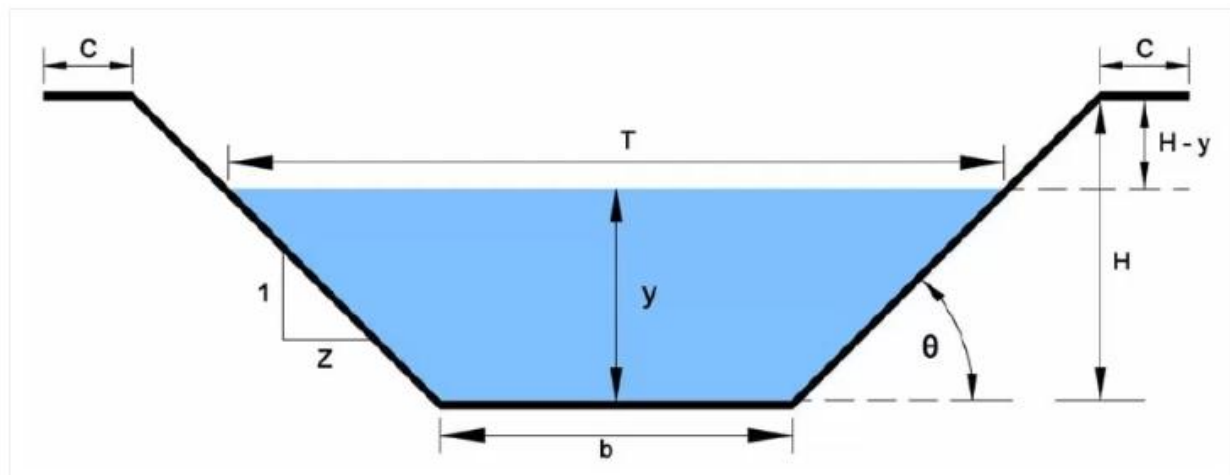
Componentes de la Sección transversal de un canal a cielo abierto. (Fuente: edición propia, 2025)
